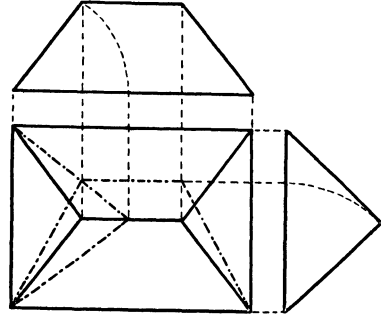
Walmdach. (Die Walmdachflächen sind steiler als die Hauptdachflächen.)
